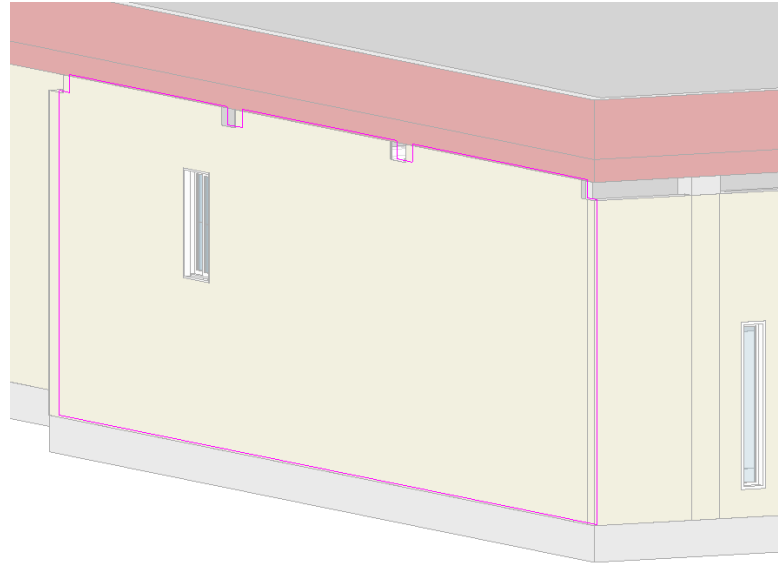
Gestión de Conflictos detectados entre Muros y Vigas Estructurales
